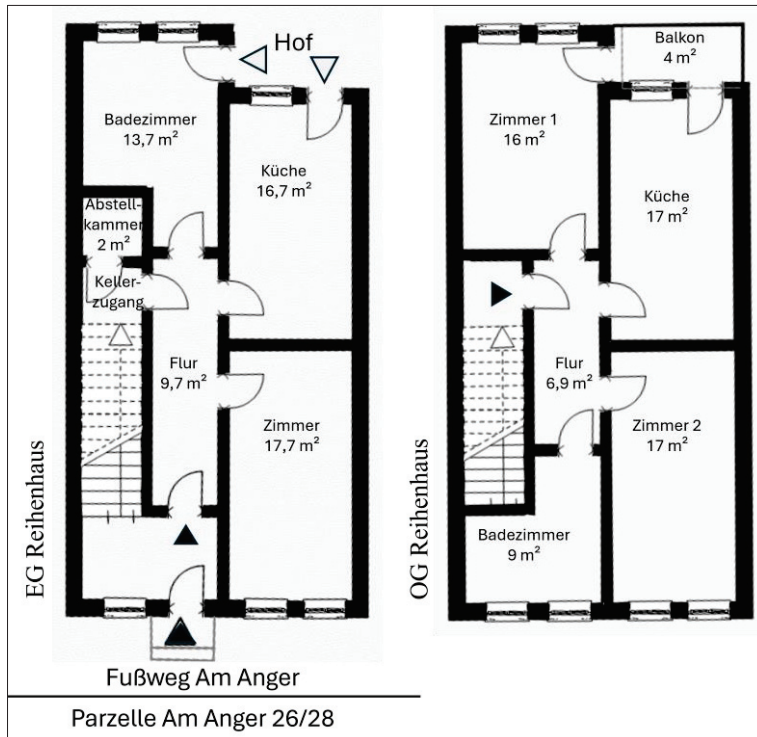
Grundriss von Erdgeschoss und Obergeschoss der Reihenhäuser. Quelle: Eigene Darstellung.
